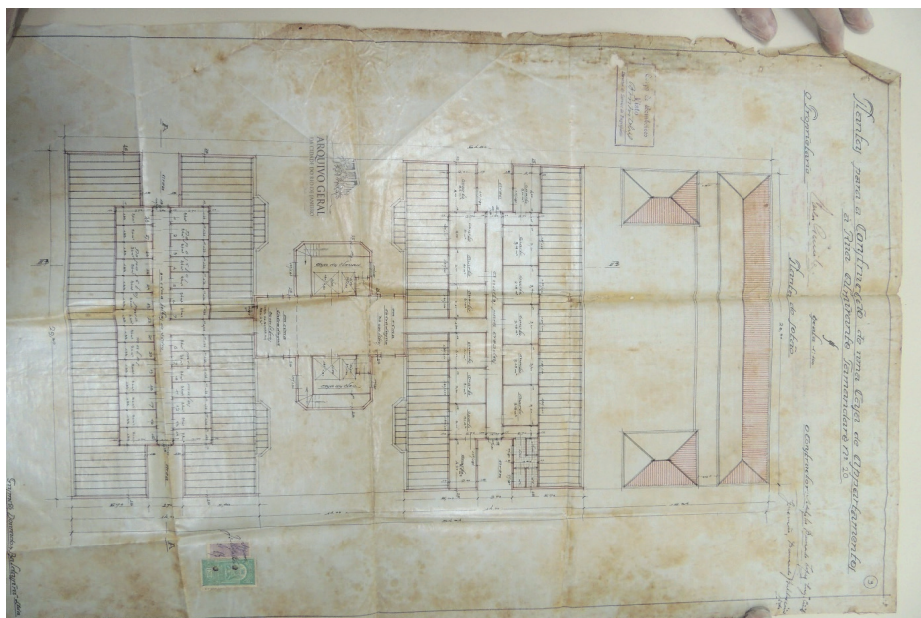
Planta baixa do pavimento de cobertura do ed. Tamandaré
